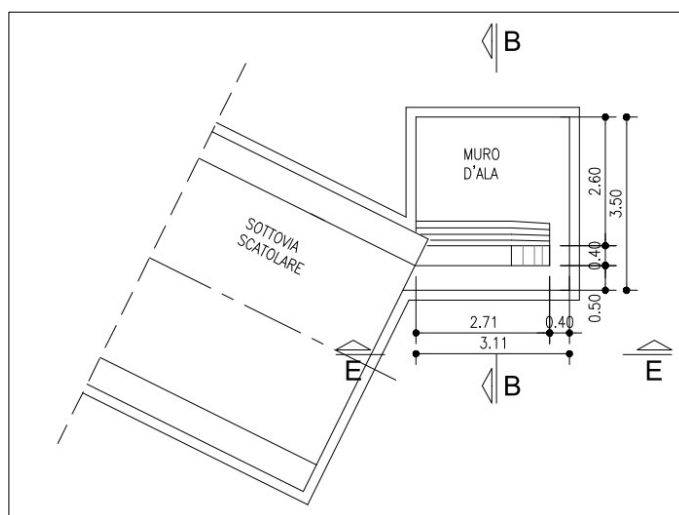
Planimetria del muro d'ala – Lato Nord
